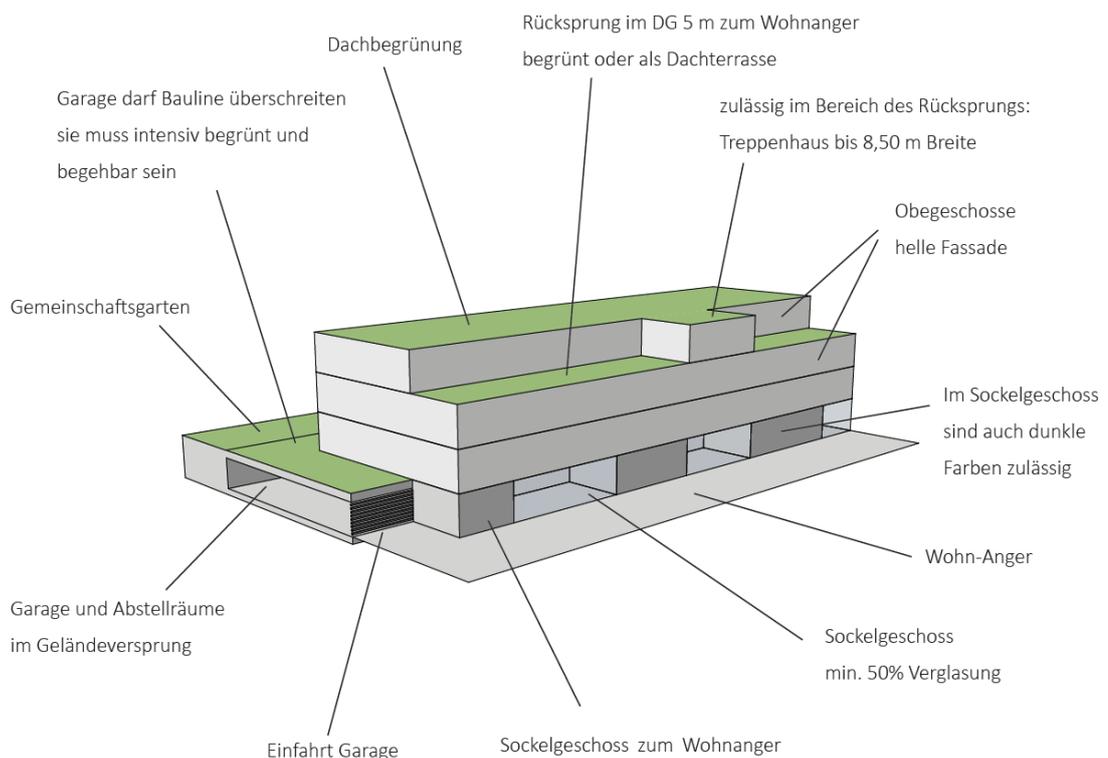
Gestaltungsaufbau eines Hybridgebäudes
